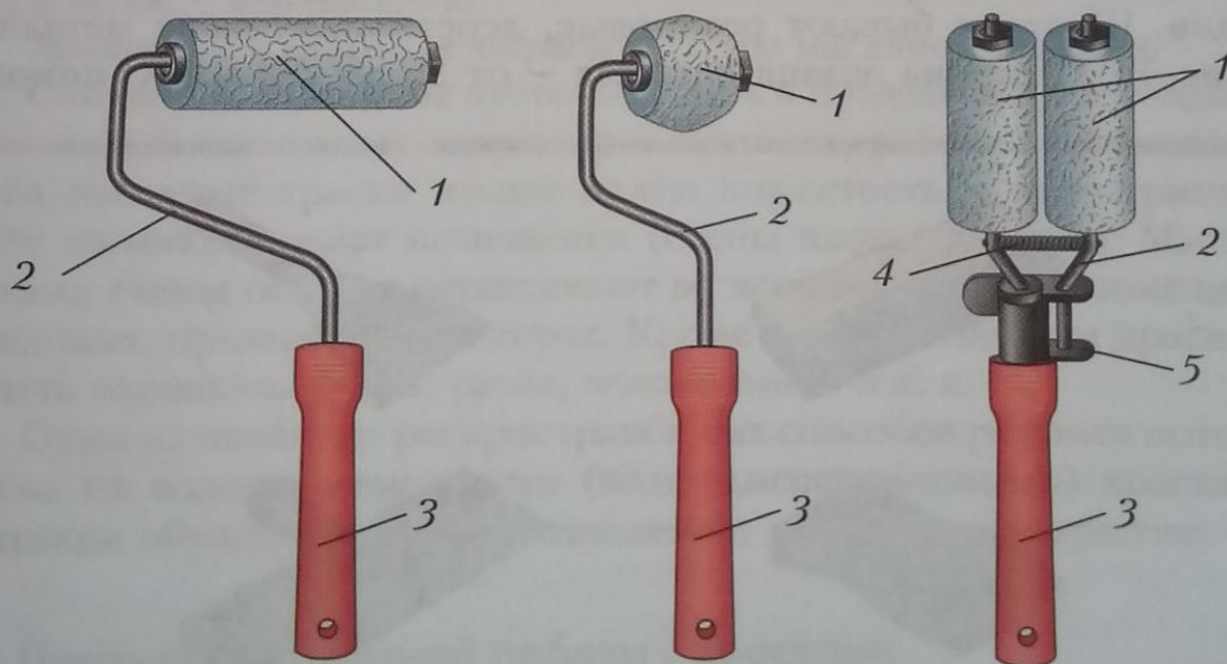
Малярные валики и их строение: 1 — валик; 2 — кронштейн; 3 — ручка; 4 — сжимное устройство; 5 — скоба
